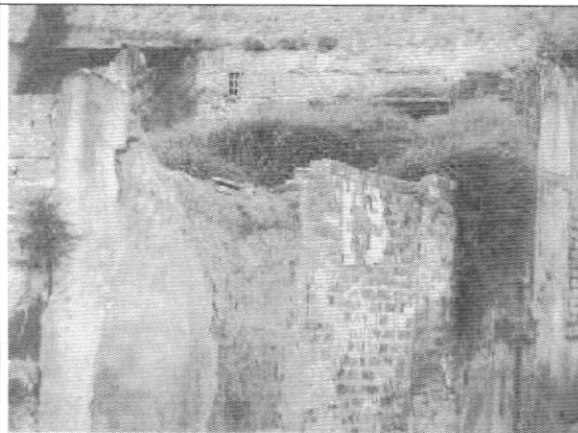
Pérdida de verticalidad muro. Empuje de terreno
